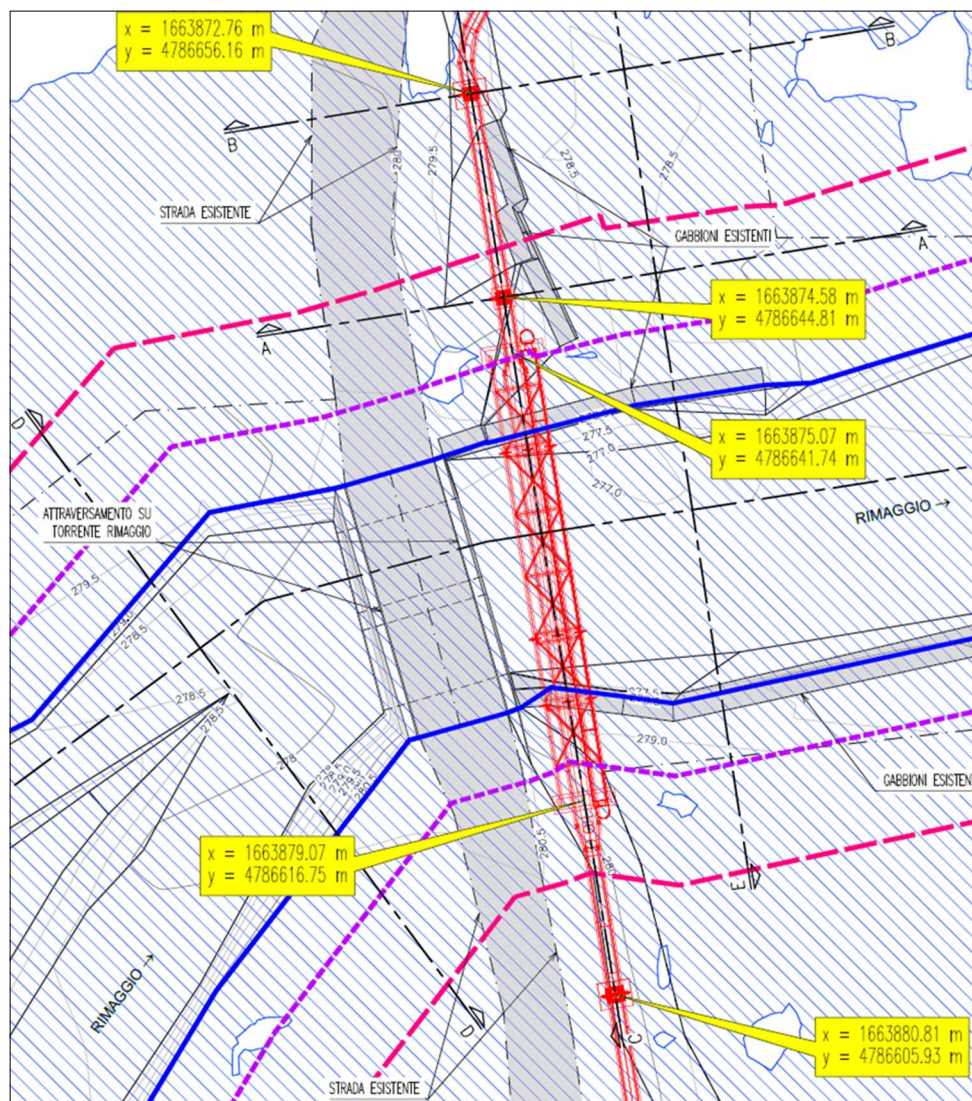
Stralcio planimetrico attraversamento vapordotto sul Torrente Rimaggio
